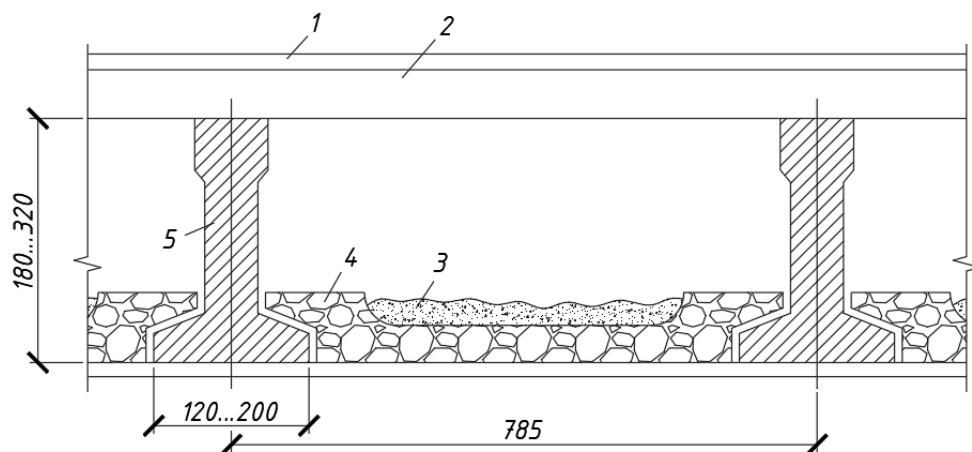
Конструкції для заміни перекриттів з залізобетонними прогонами двотаврового перетину: 1 - дерев'яна підлога; 2 - дерев'яні лаги; 3 - утеплювач; 4 - легкобетонна плита-вкладиш; 5 - залізобетонний прогін двотаврового перетину
